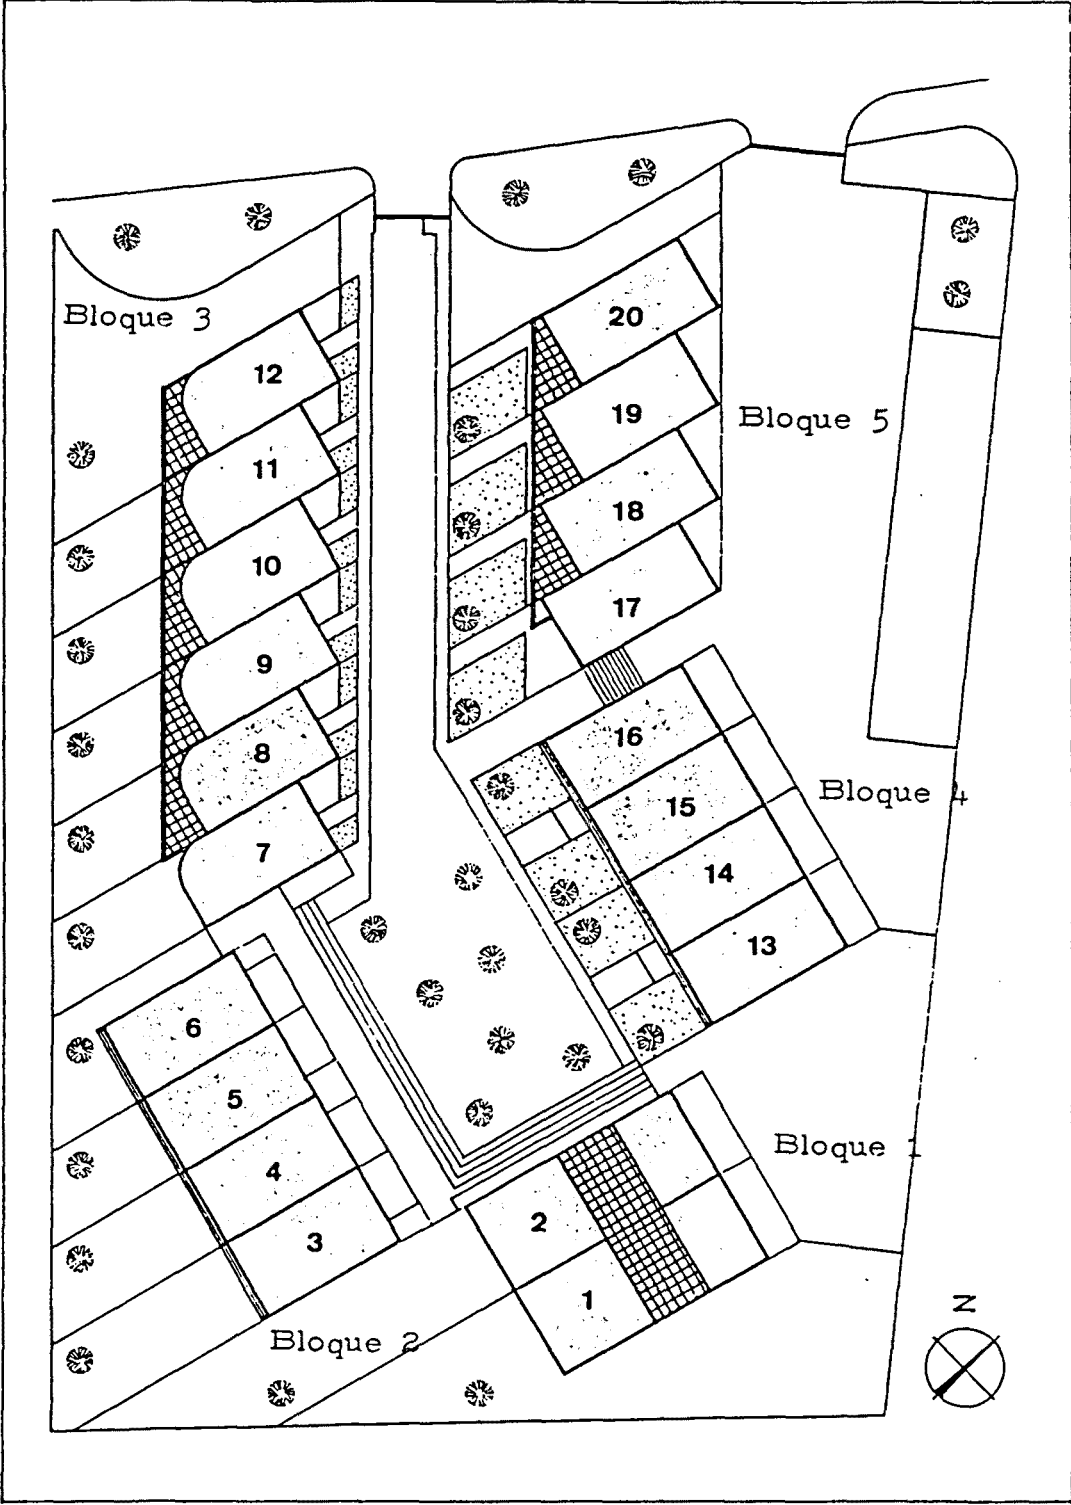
Plano de conjunto del campo bioclimático de Begues.
